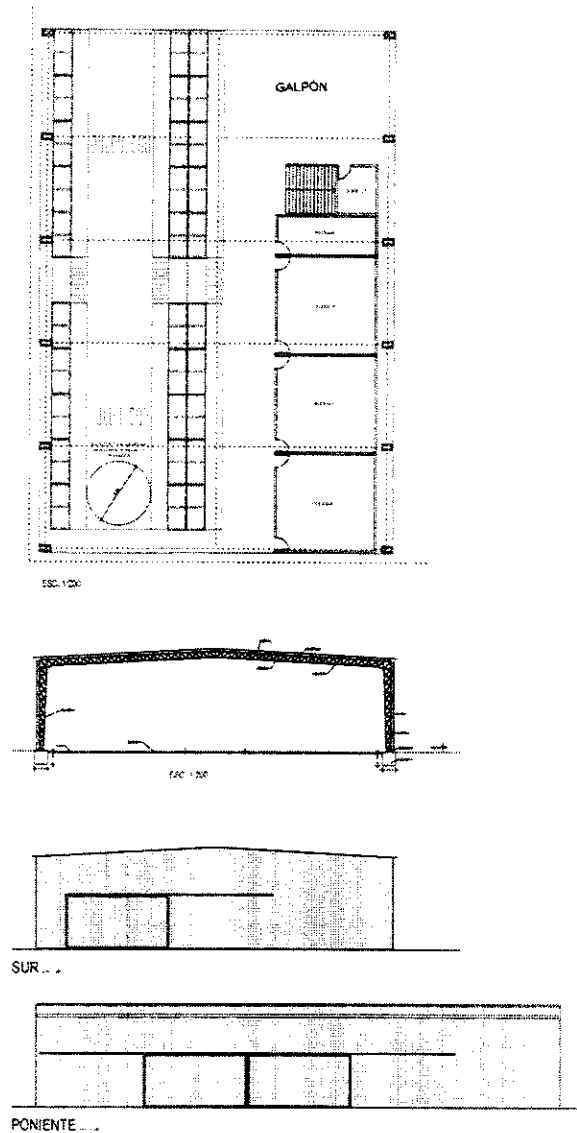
Planimetría Situación Propuesta Bodega Cauquenes – Detalles.
